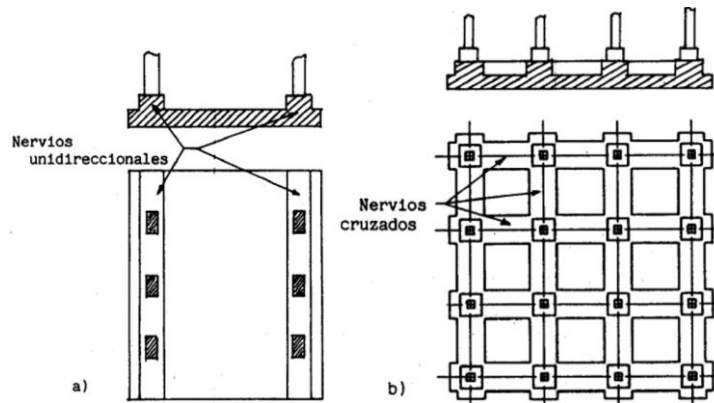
, tipos de platea de cimentación, fuente libro de diseño estructural.
